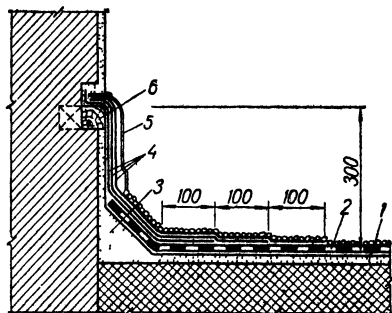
Примыкание кровли из рулонных материалов к кирпичной стене:
